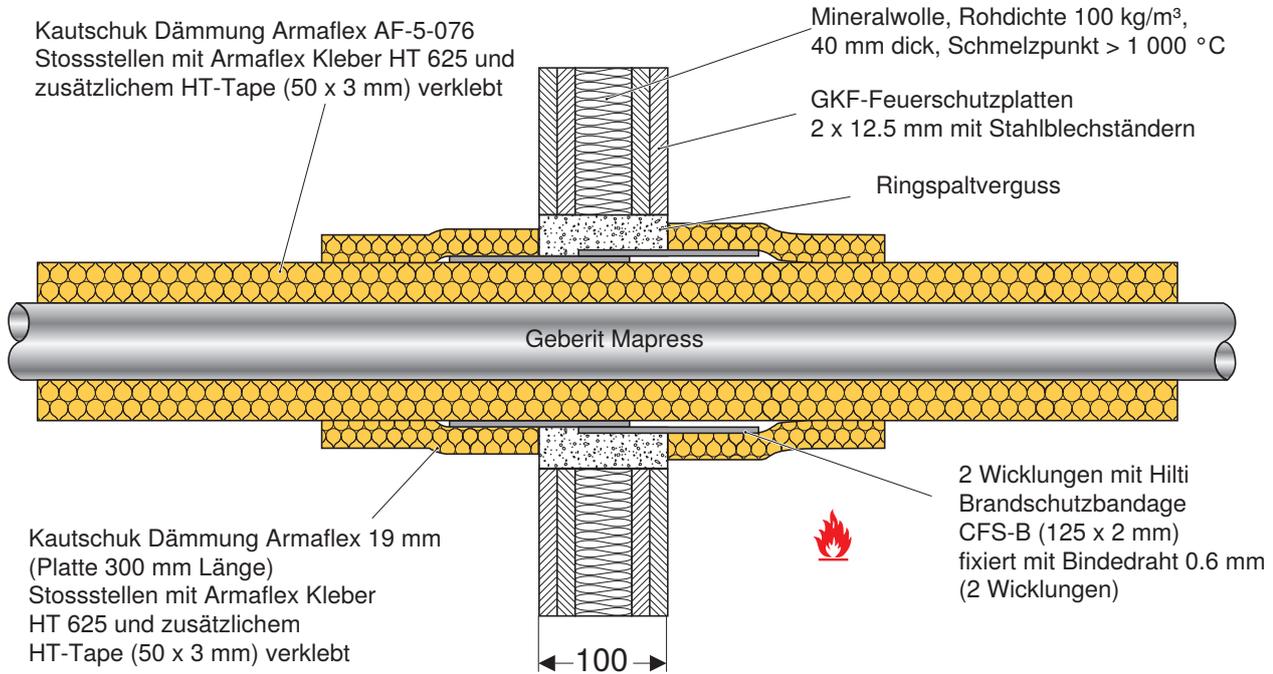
Wanddurchführung Massivwand/Leichtbauwand
